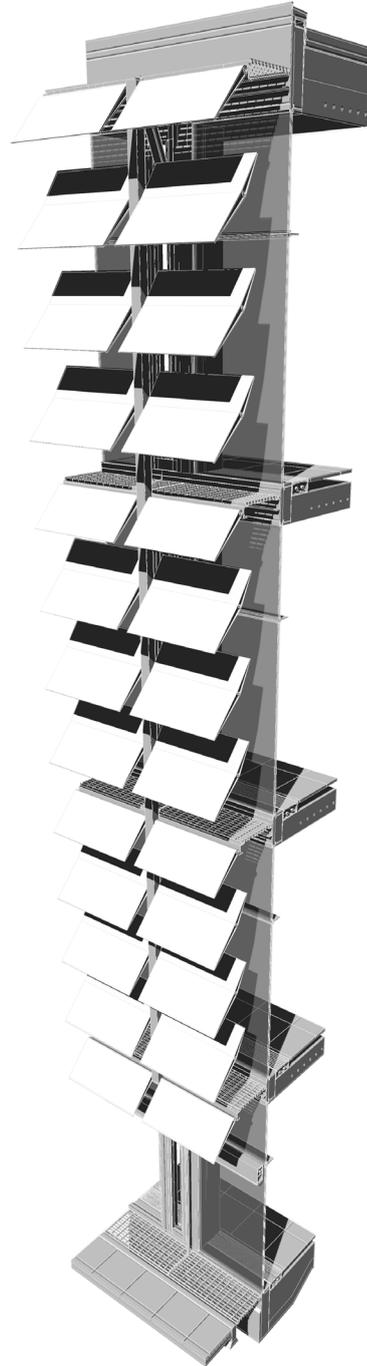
Fassade _ Gesamt Lamellen 45 Grad Stellung
